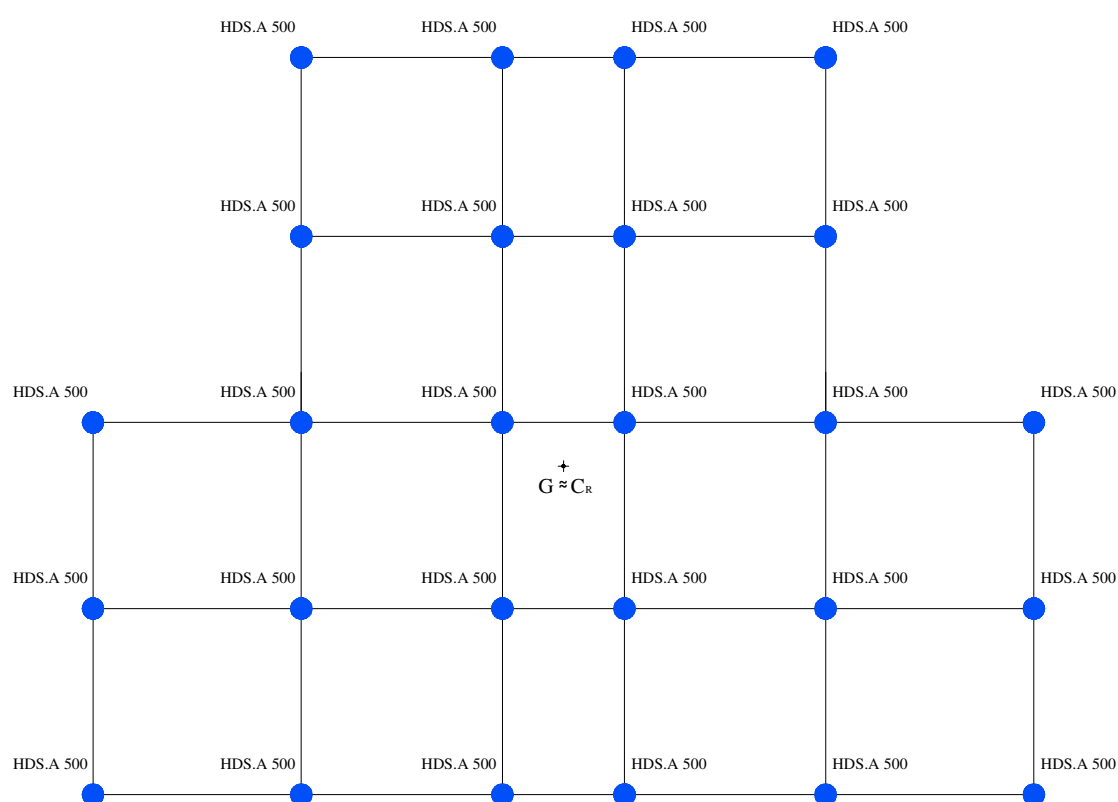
Disposizione in pianta dei dispositivi di isolamento (caso a)
